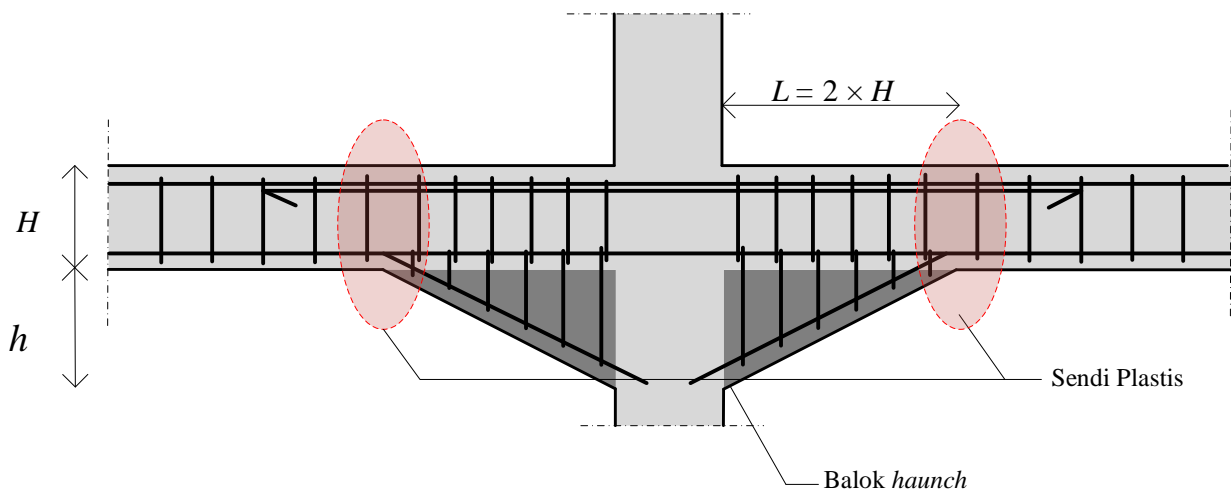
3. Detail penulangan balok di muka kolom
